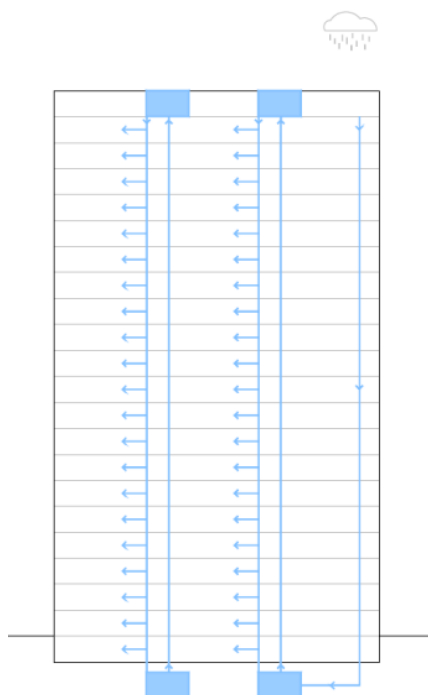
Diagrama de zoneamento por pavimento de cultivo.
